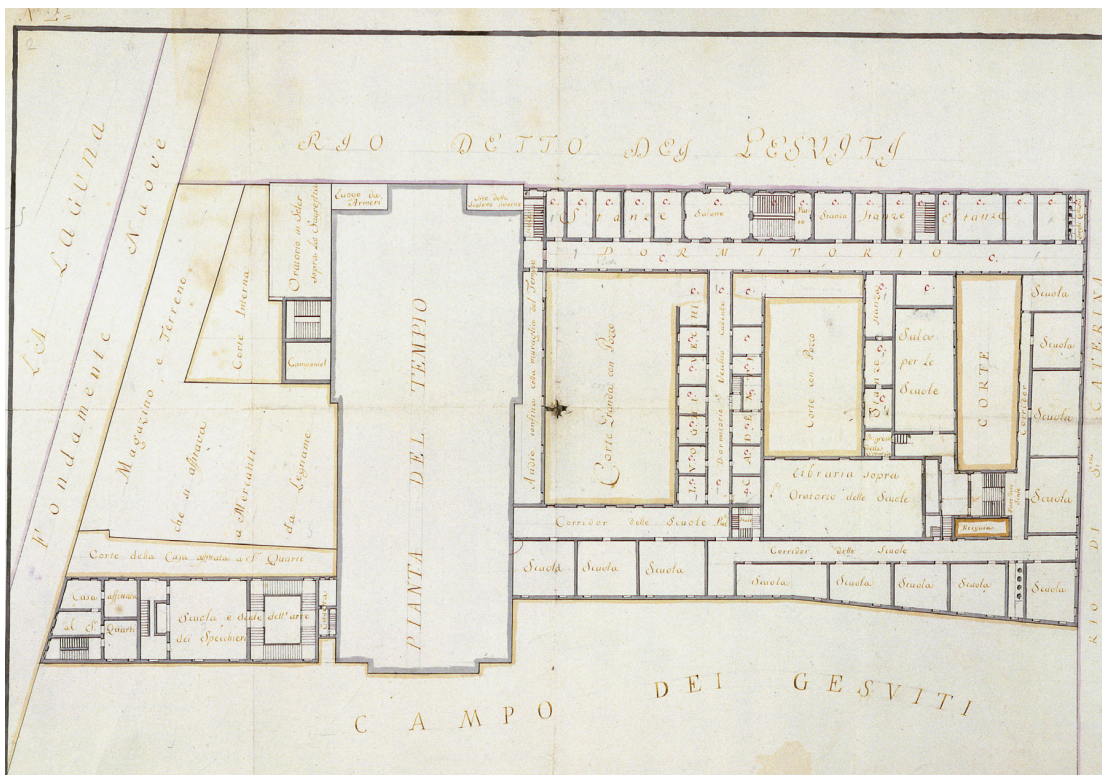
Planimetria del primo piano dell'ex complesso dei Gesuiti, *post* 1773 (ASVe, Aggiunto sopra i monasteri, dis. 89)
